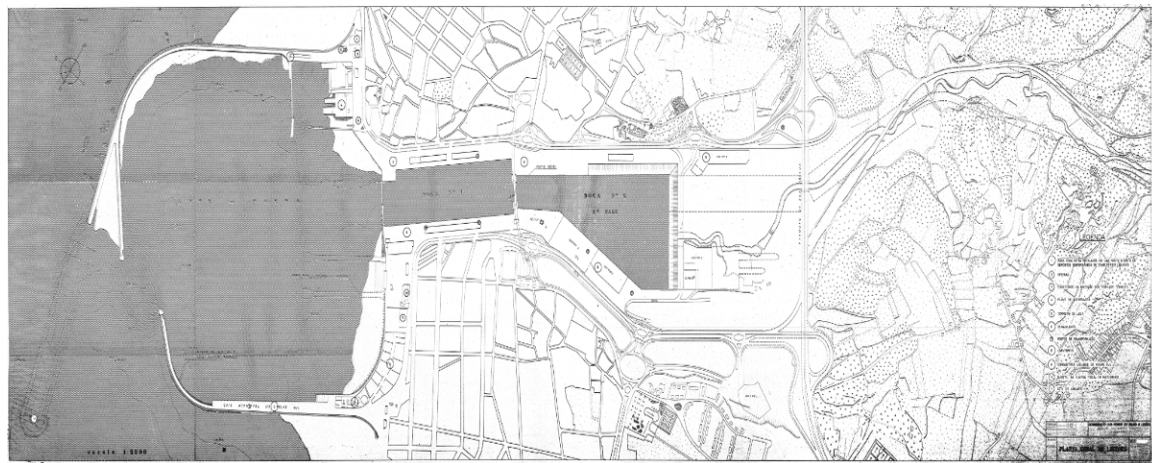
Planta Geral _ Ampliação do Porto de Leixões_ Arquivo da APDL
